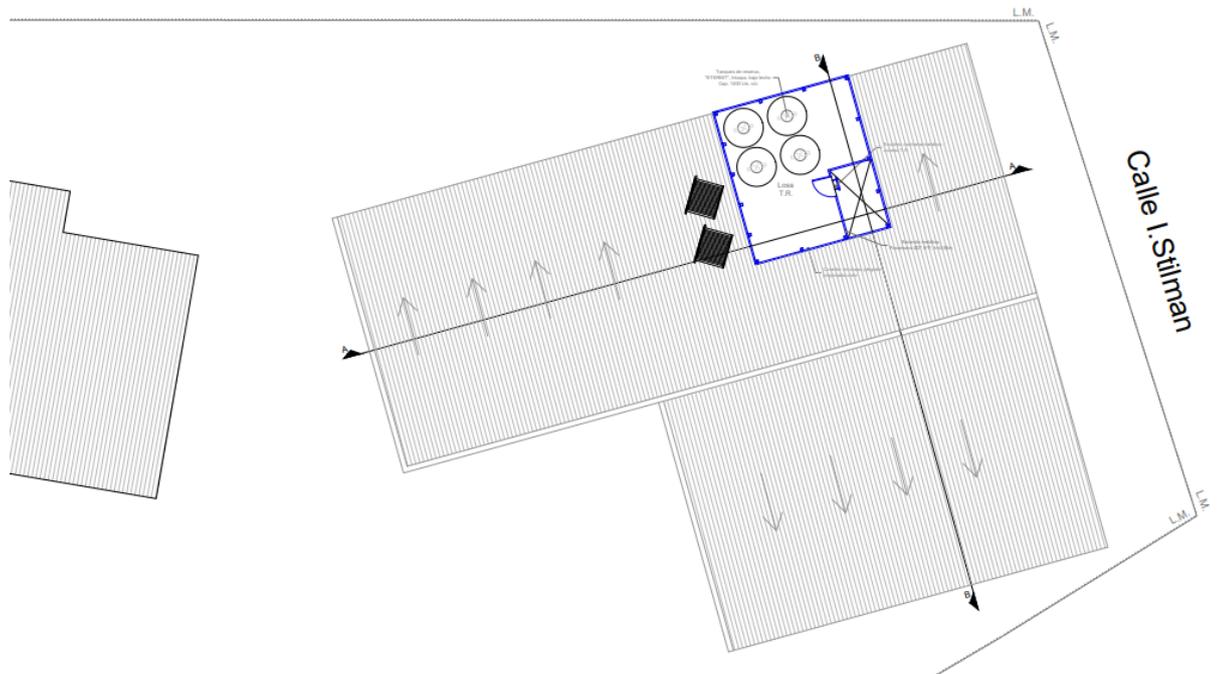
Planta Tanques. Edificio anexo Centro Cívico.
